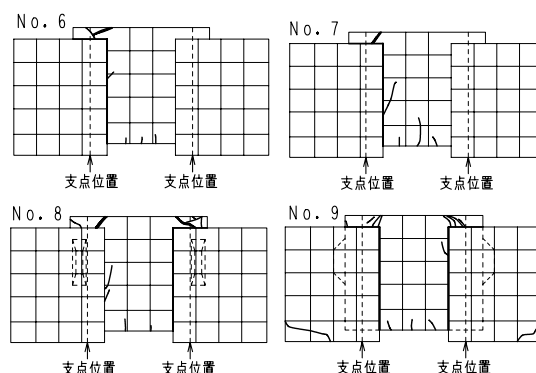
供試体ひび割れ図 (B シリーズ)
